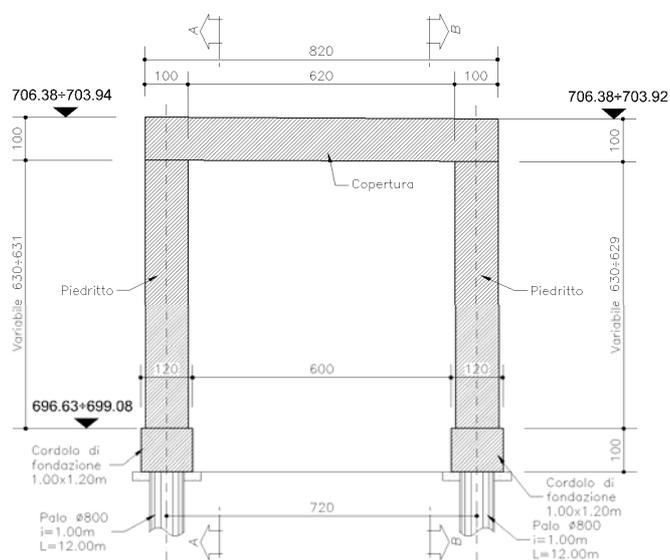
Sezione trasversale tipo - Dettagli di carpenteria
